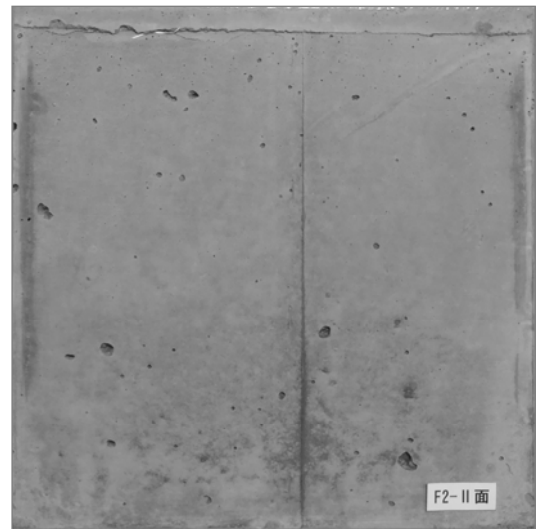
表面気泡の状況 (試験体 F, 不織布面)
